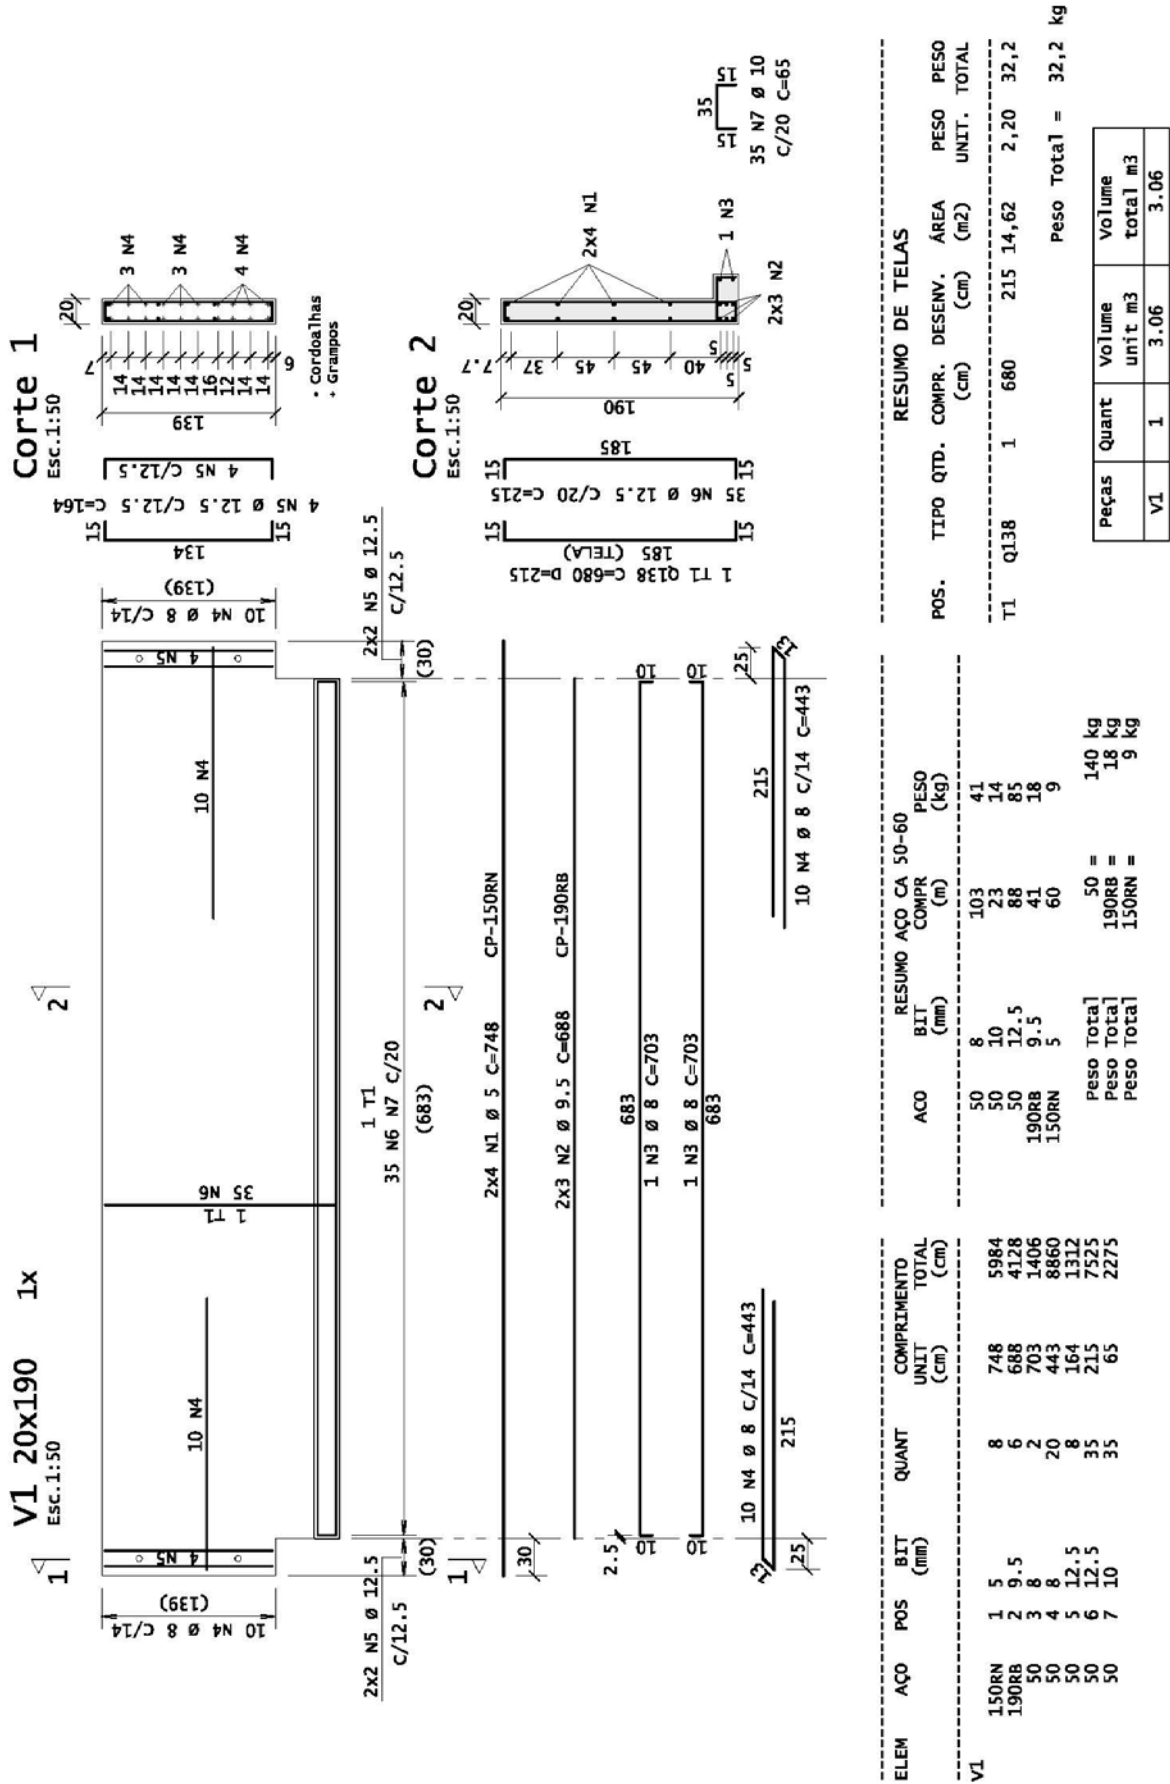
Configuração final da armadura para viga de seção “L” do exemplo
